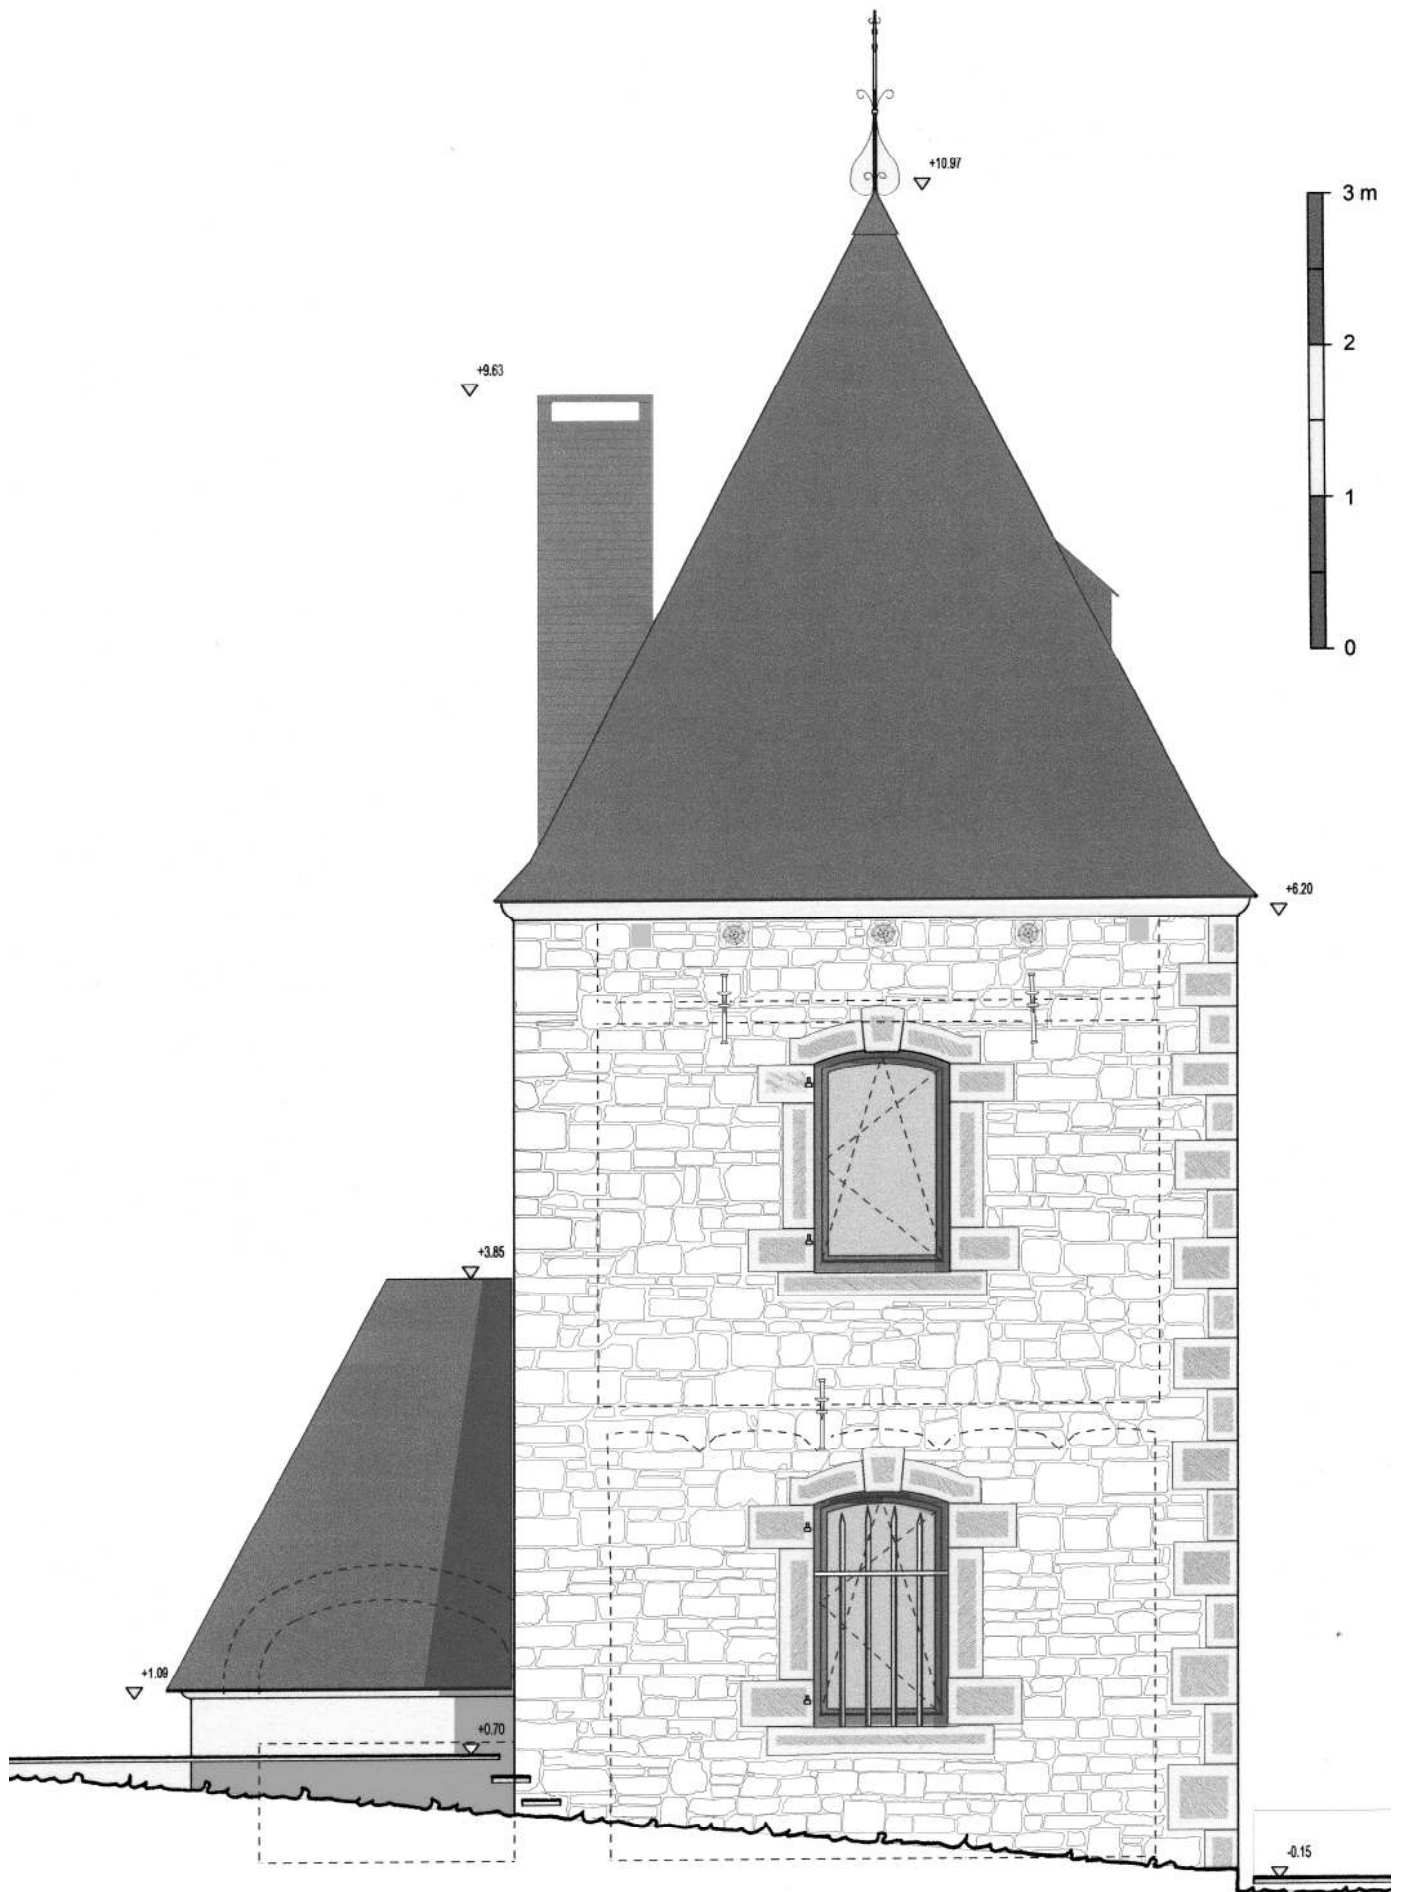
Pavillon. Elévation NE. Ech. 1/50°. Situation projetée. IG 2008.
